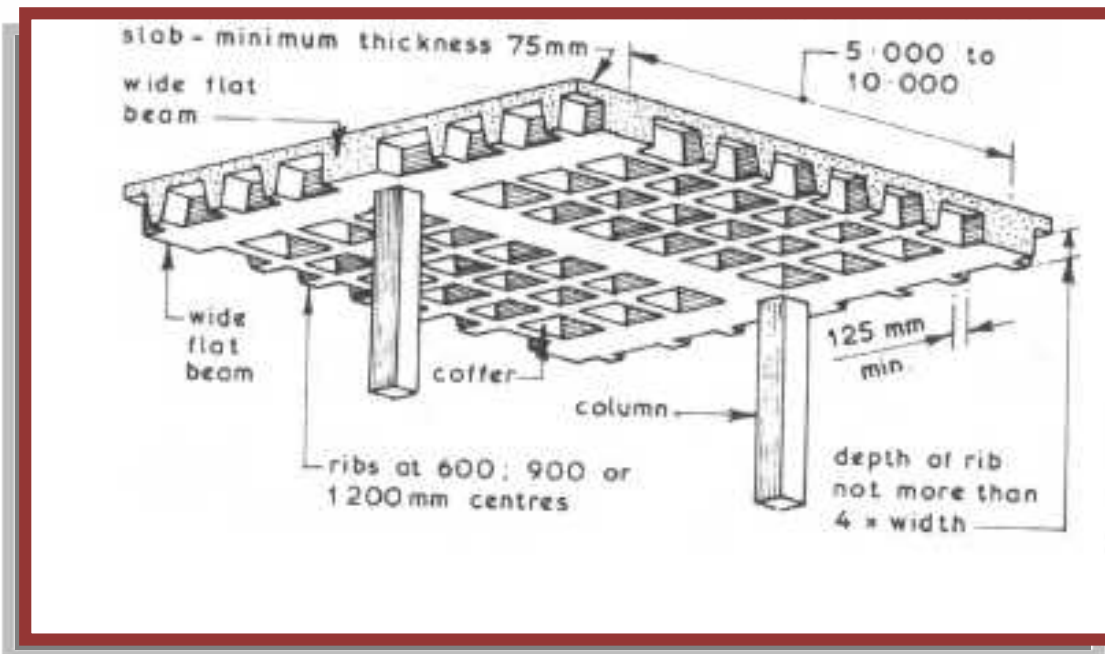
مقطع من عقدة الأعصاب
